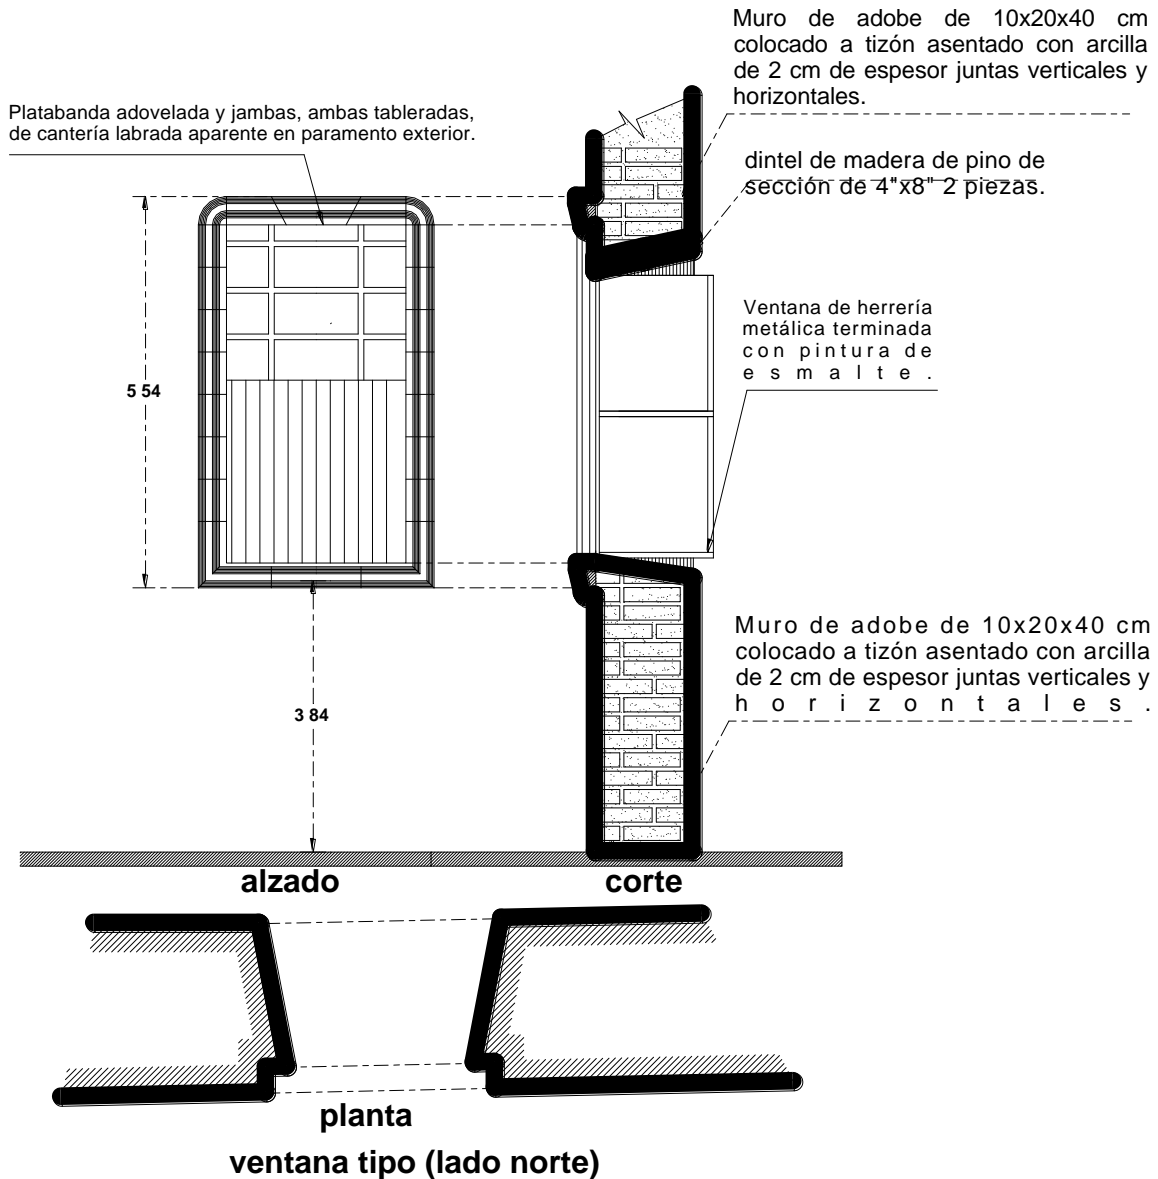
Vista y detalle constructivo de los cerramientos de los vanos de la fachada norte.
